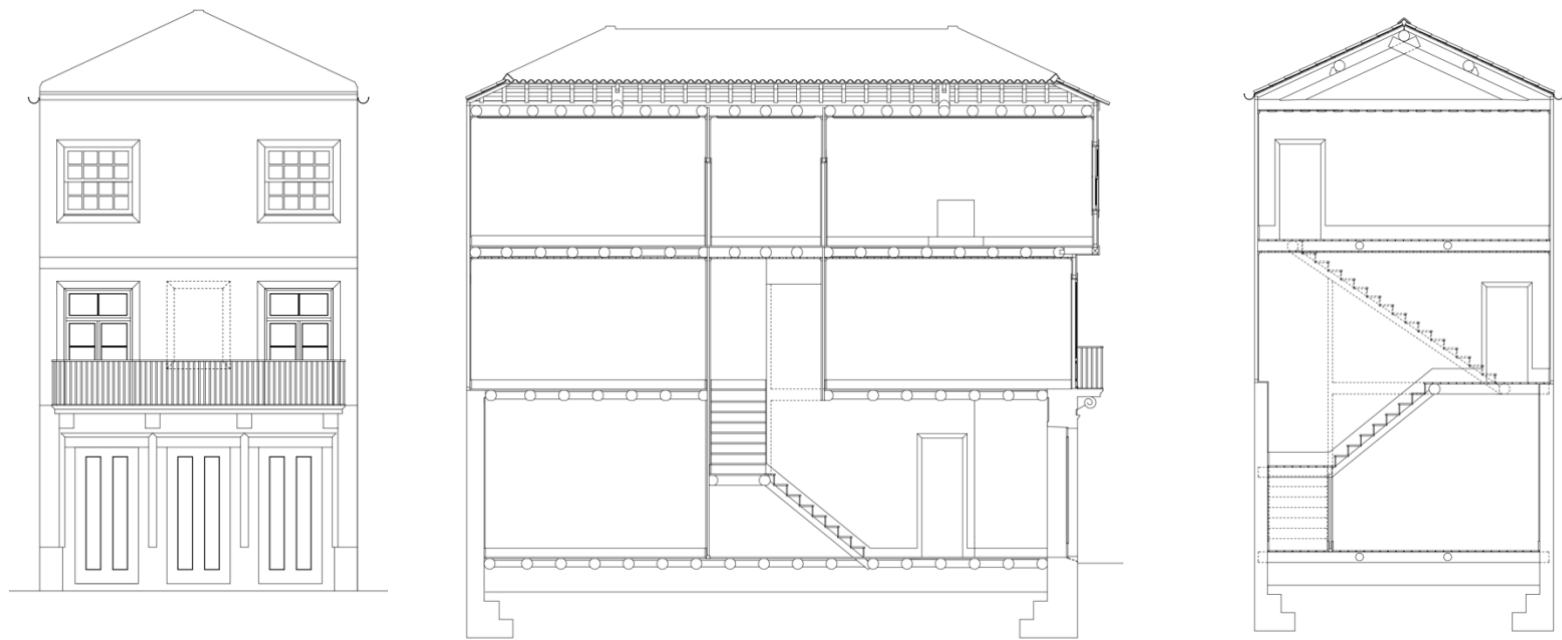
Alçado principal, corte longitudinal e corte transversal da casa Mercantilista (extraído de Teixeira: 2013).
